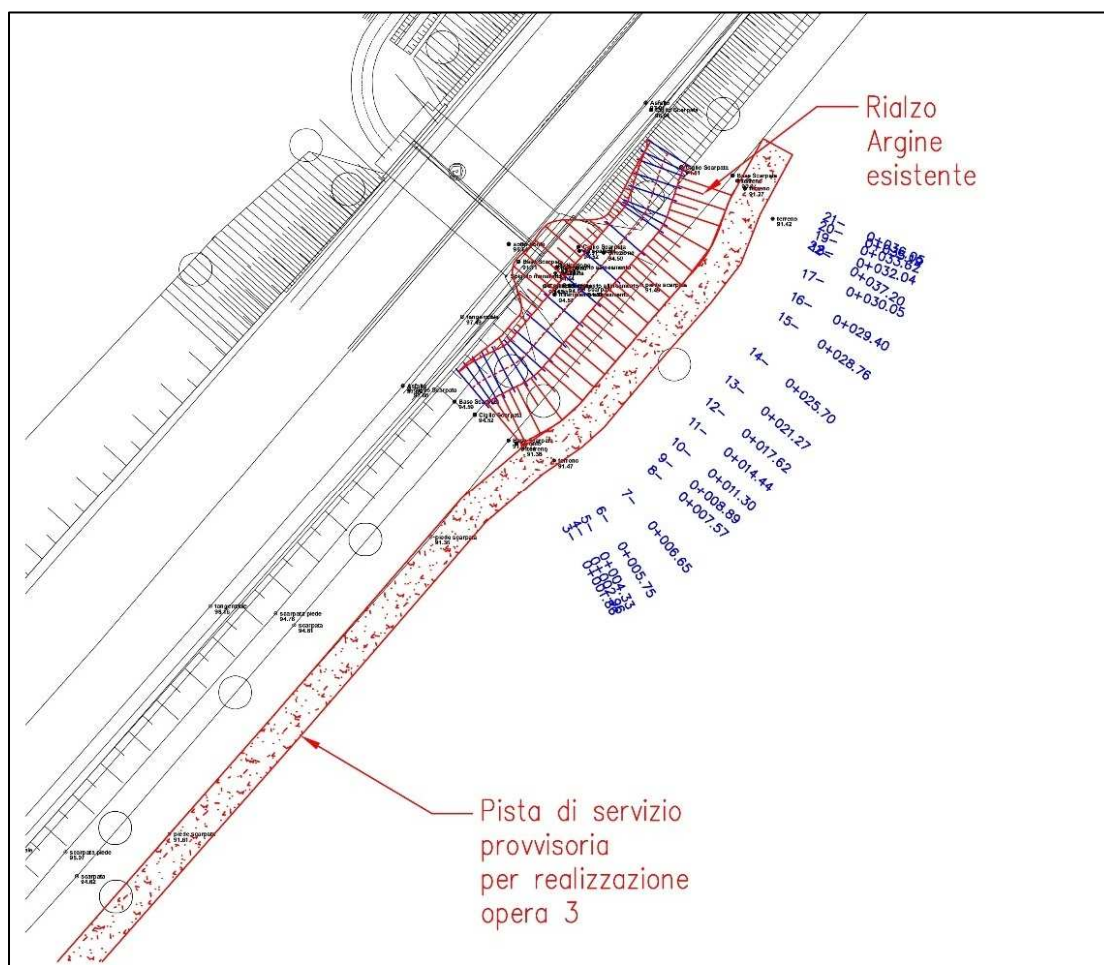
Arginatura chiusura terzo fornice – Planimetria
